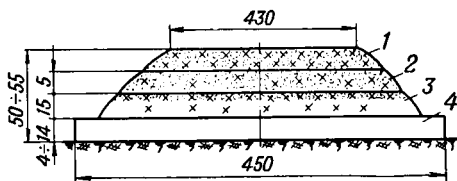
Конструкция уса на хворостяной выстилке с прослойкой грунта:
